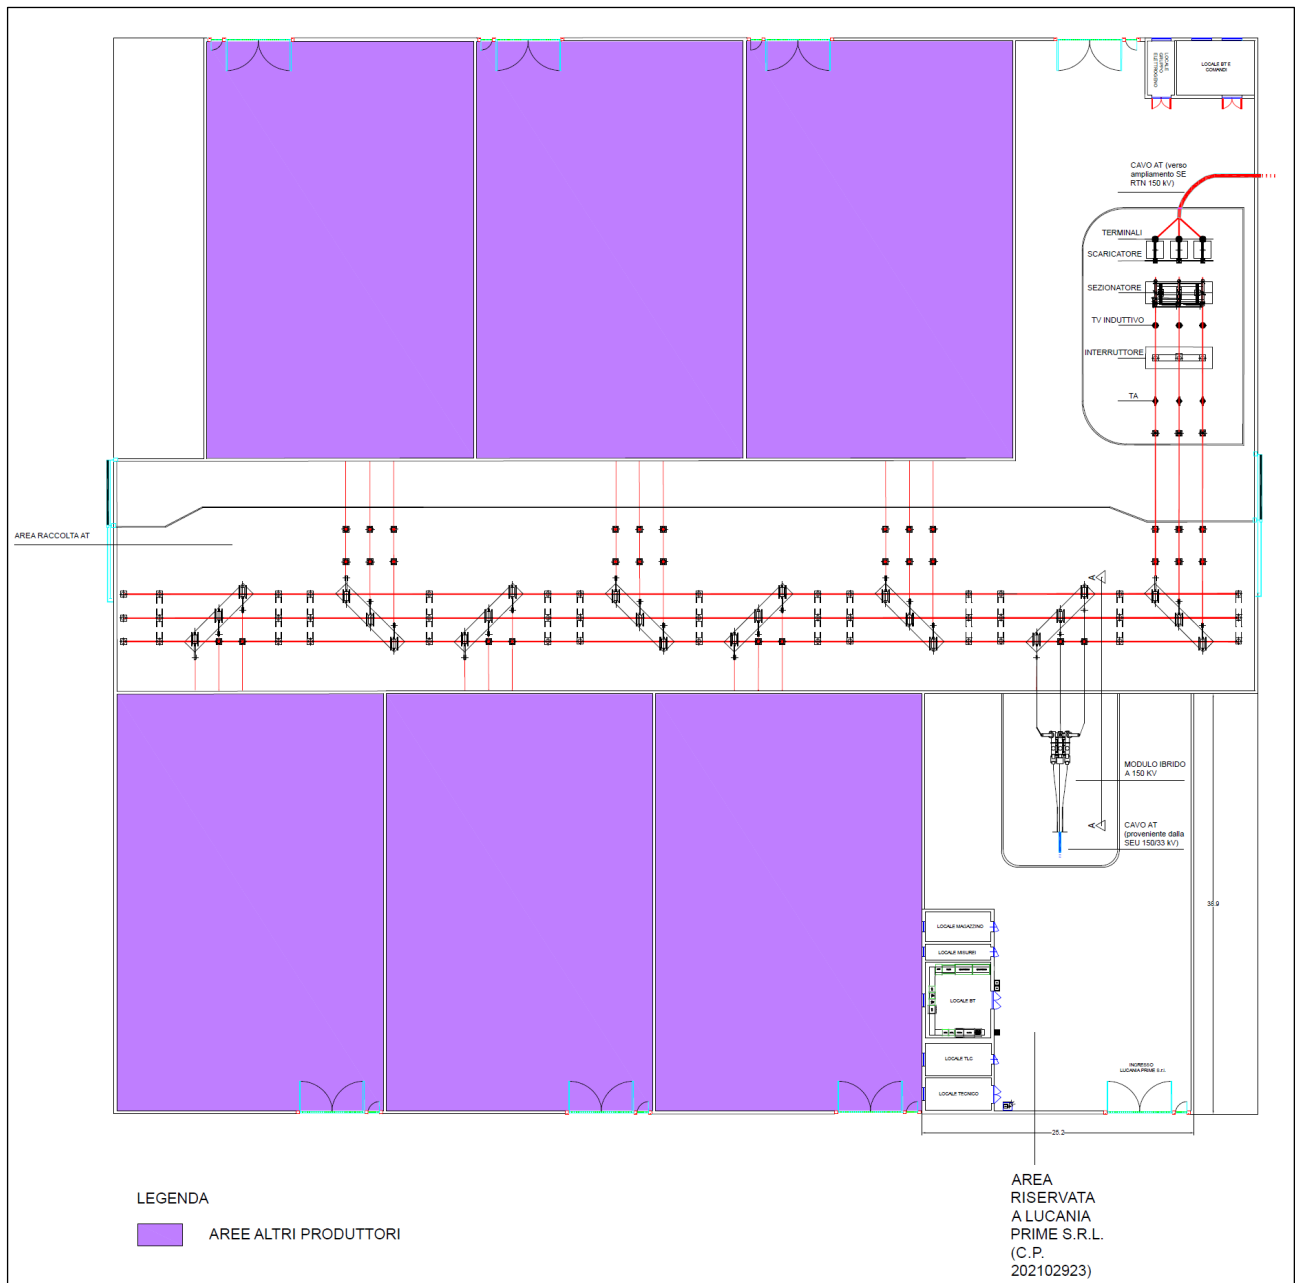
Planimetria elettromeccanica della Stazione Elettrica Condivisa
